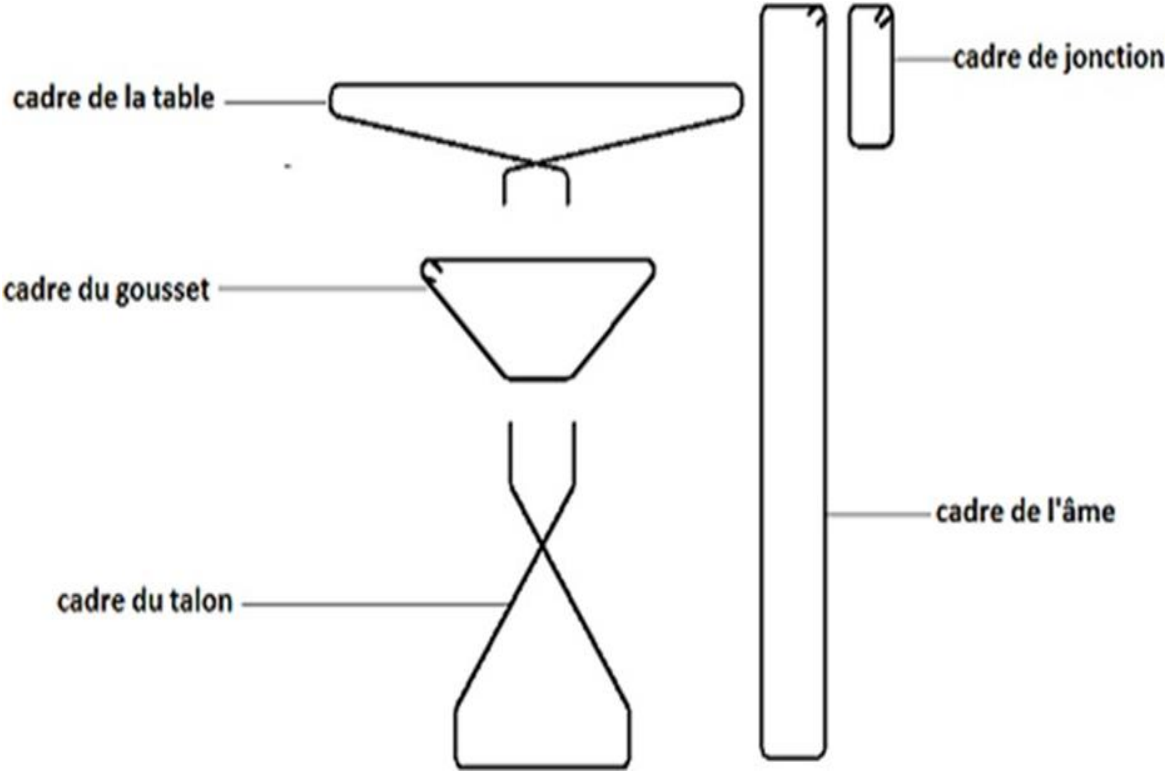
Détail du ferrailage transversal passif de la poutre
